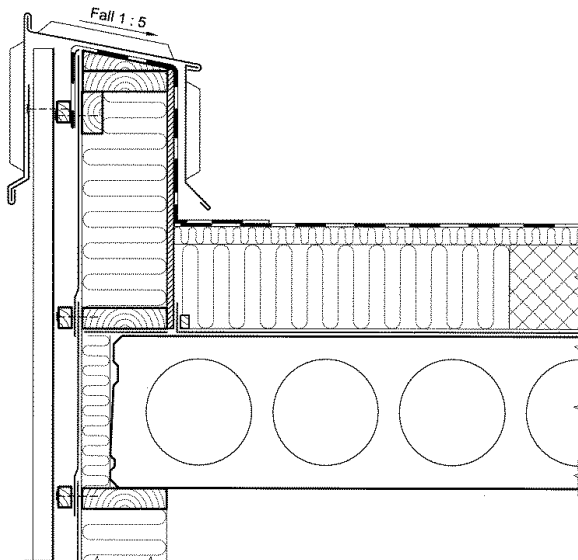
Lufttette overganger tak/parapet og parapet/vegg samt lufttett takkonstruksjon er viktig
